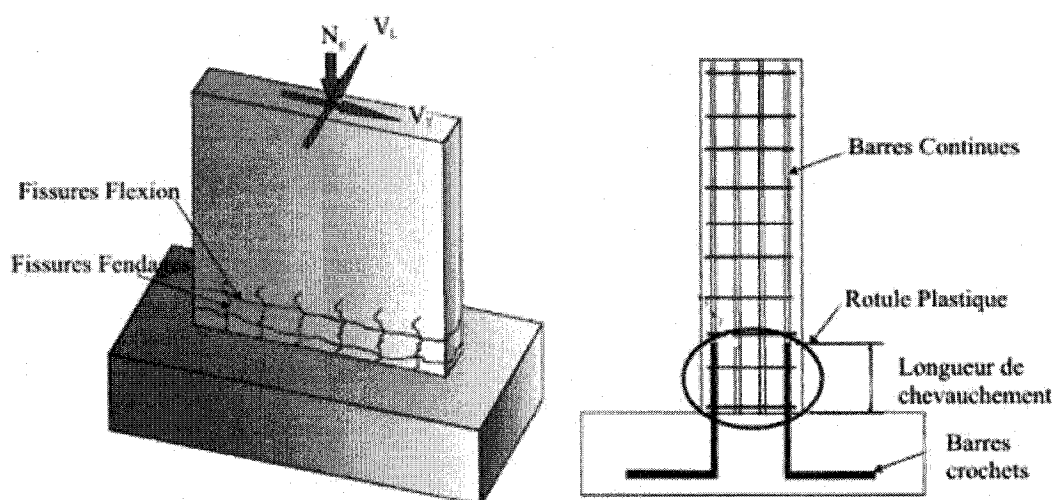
Schéma de la zone de chevauchement d'armatures et des fissures s'y développant (adapté de Vachon, 2004)
